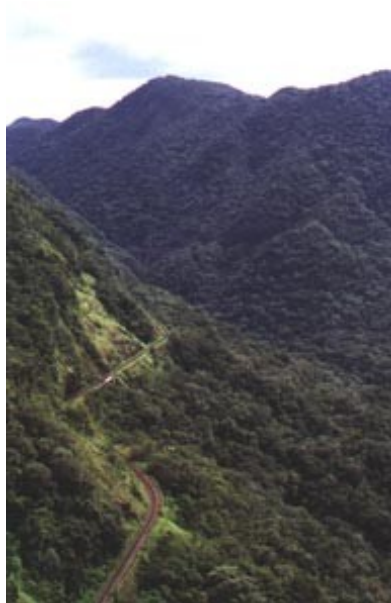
e Foto 68 - Serra do Mar – Estrada de Ferro
